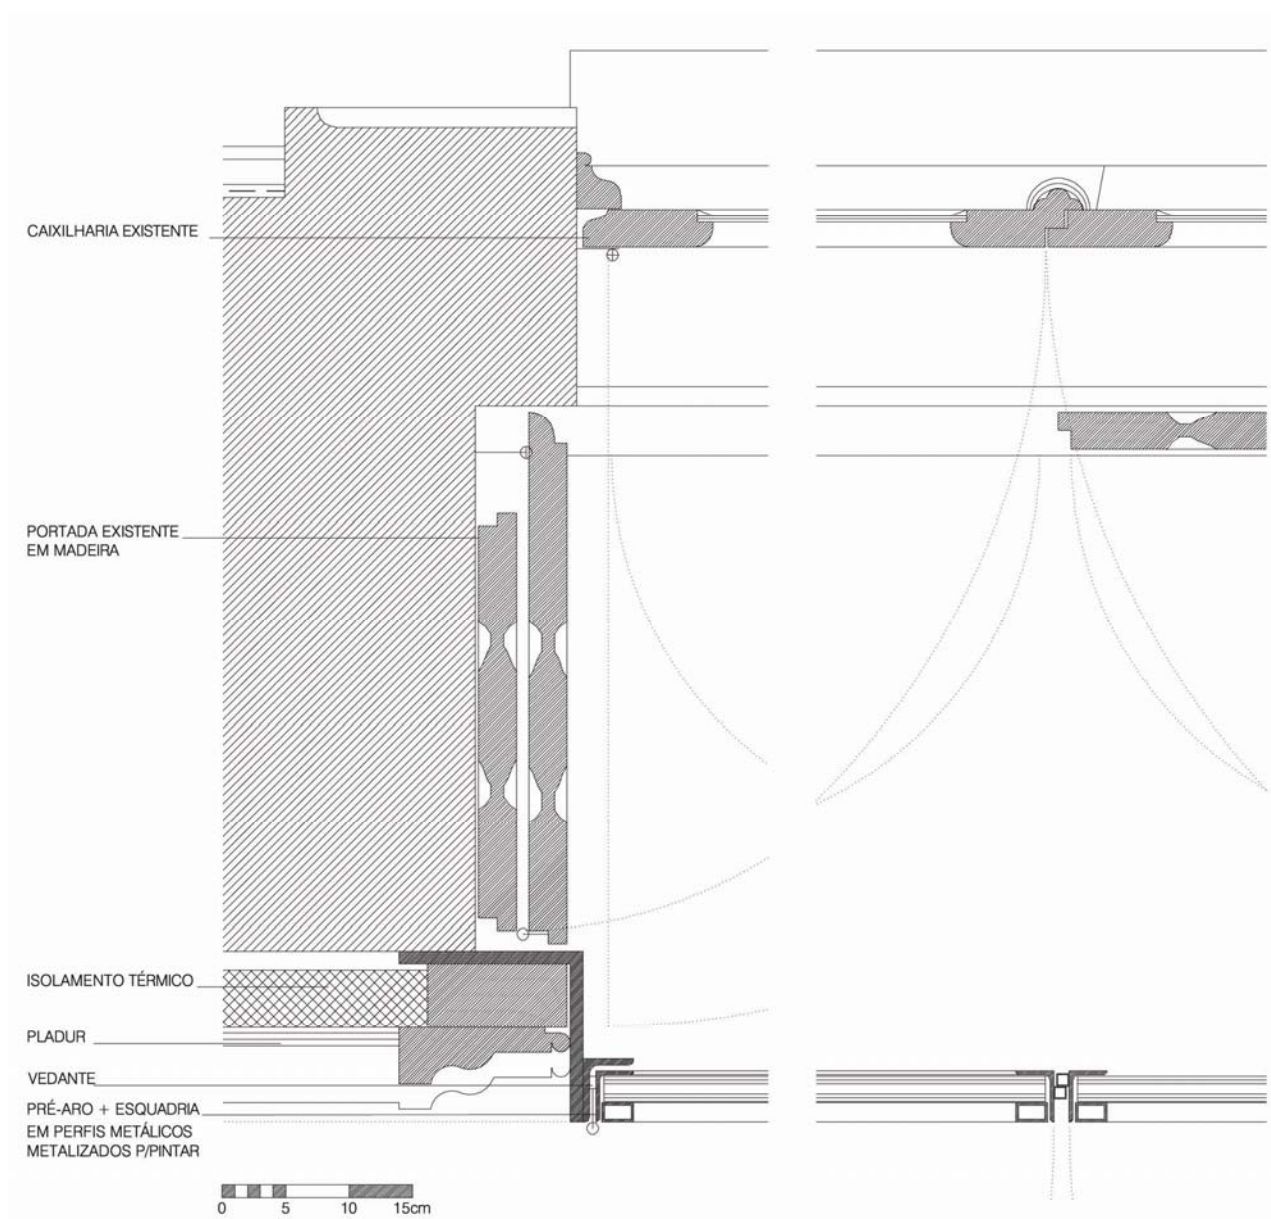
Conservação da caixilharia existente e introdução de uma segunda caixilharia interior - pormenor do corte horizontal.
